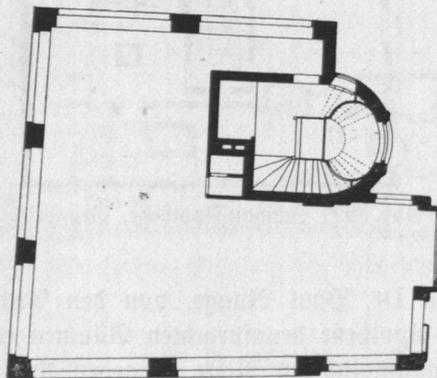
Hulbe-Haus, Grundriß des Erdgeschosses.
